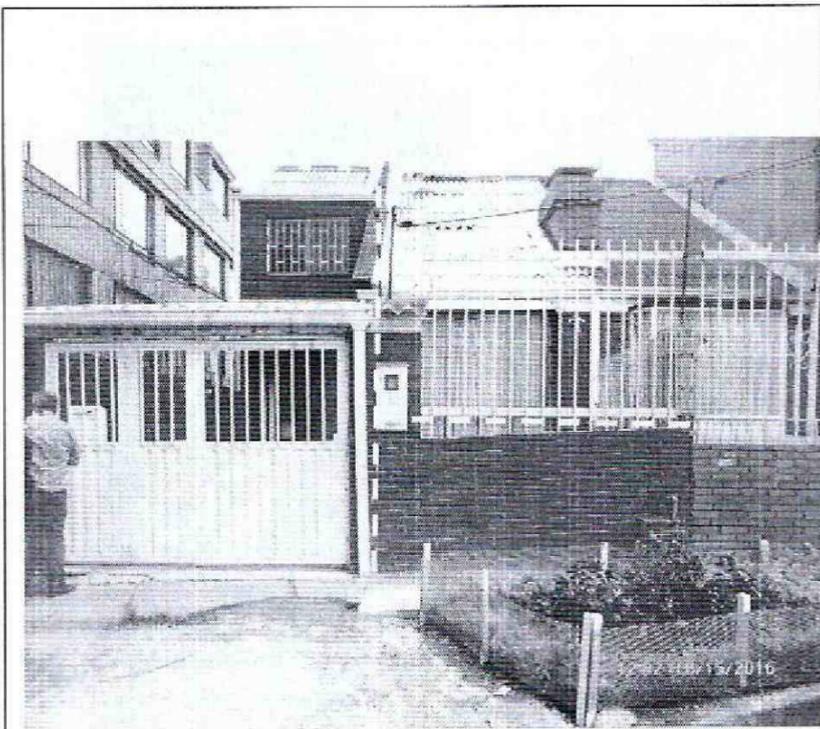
Vista del predio de la Calle 95 No 68C – 38 donde se evidencia la pérdida de verticalidad del cerramiento, grietas en pisos de 7cm y separación de la baldosa.
